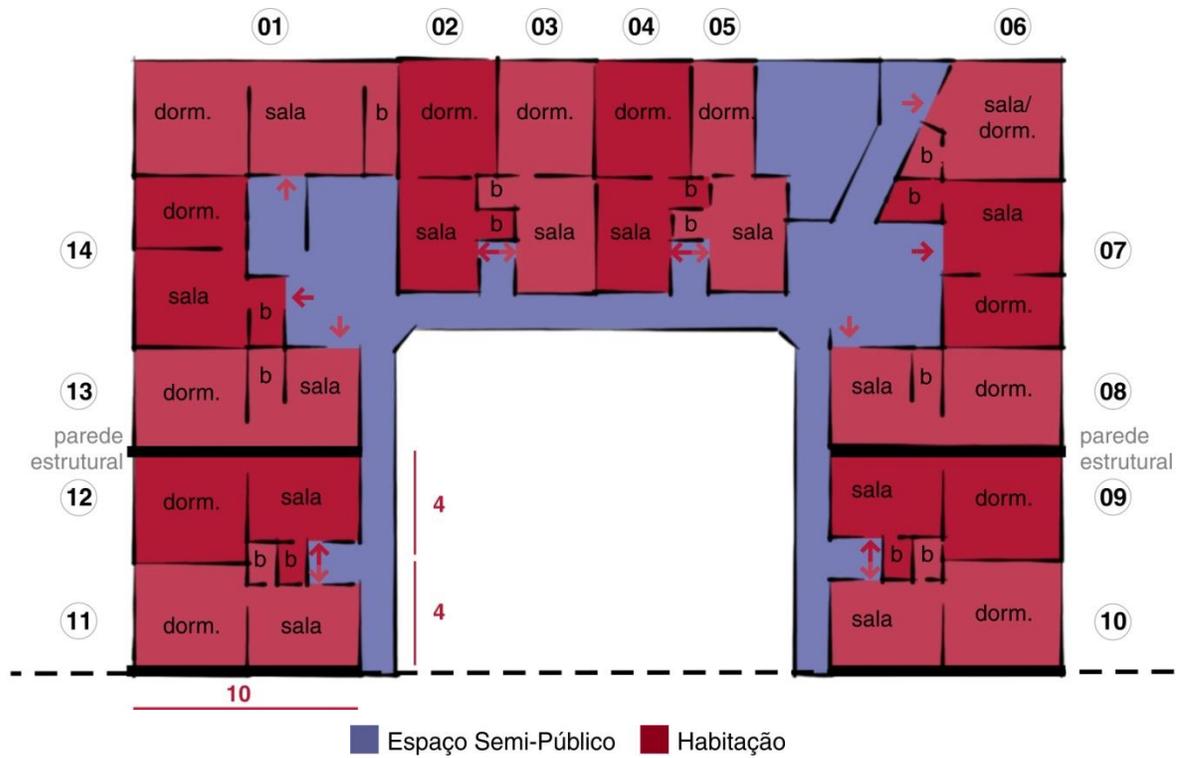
| Familistério - Planta apartamentos Pavilhão Central (Palácio Social) | Desenho da Autora
